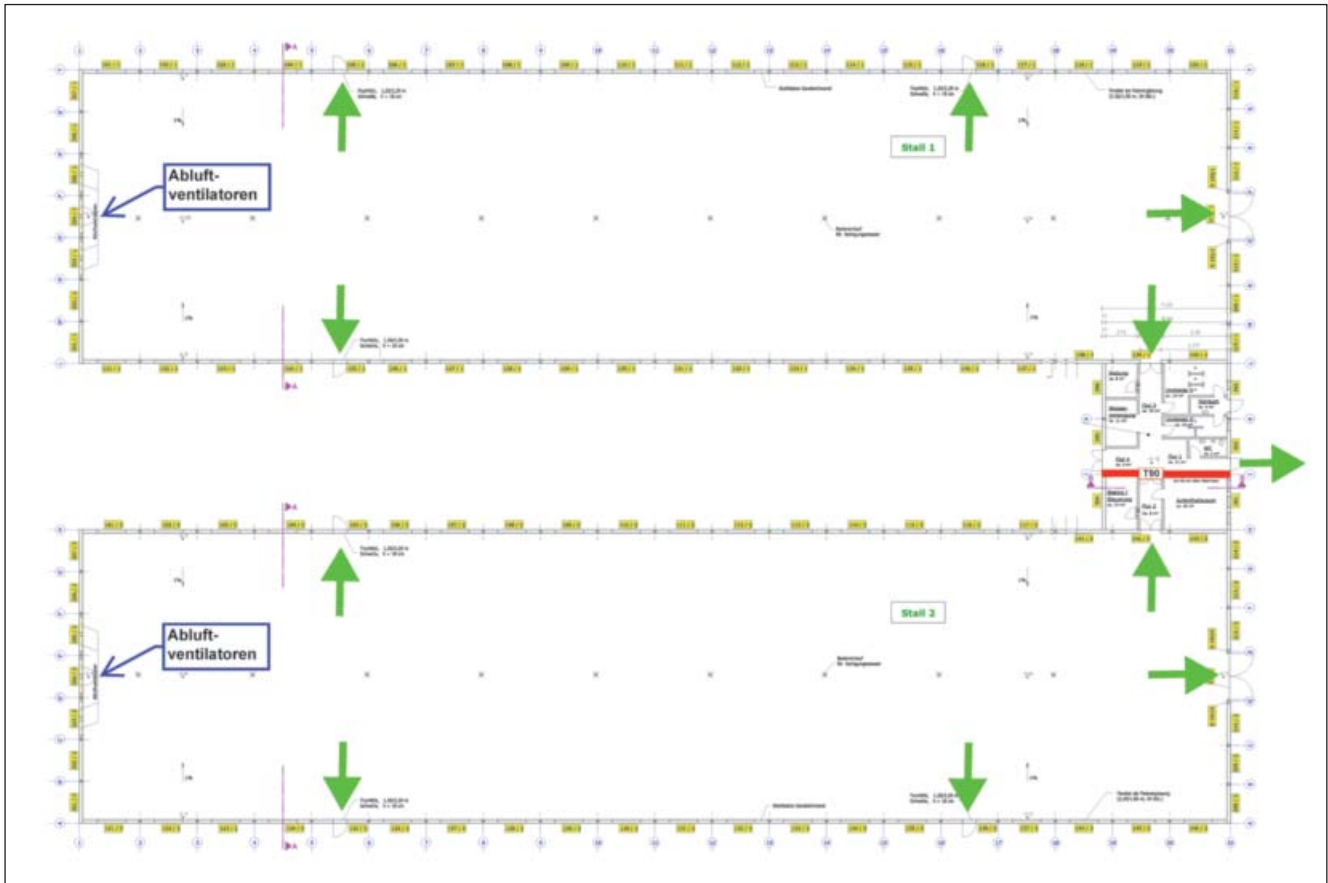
Grundriss der Legehennenaufzuchtanlage
